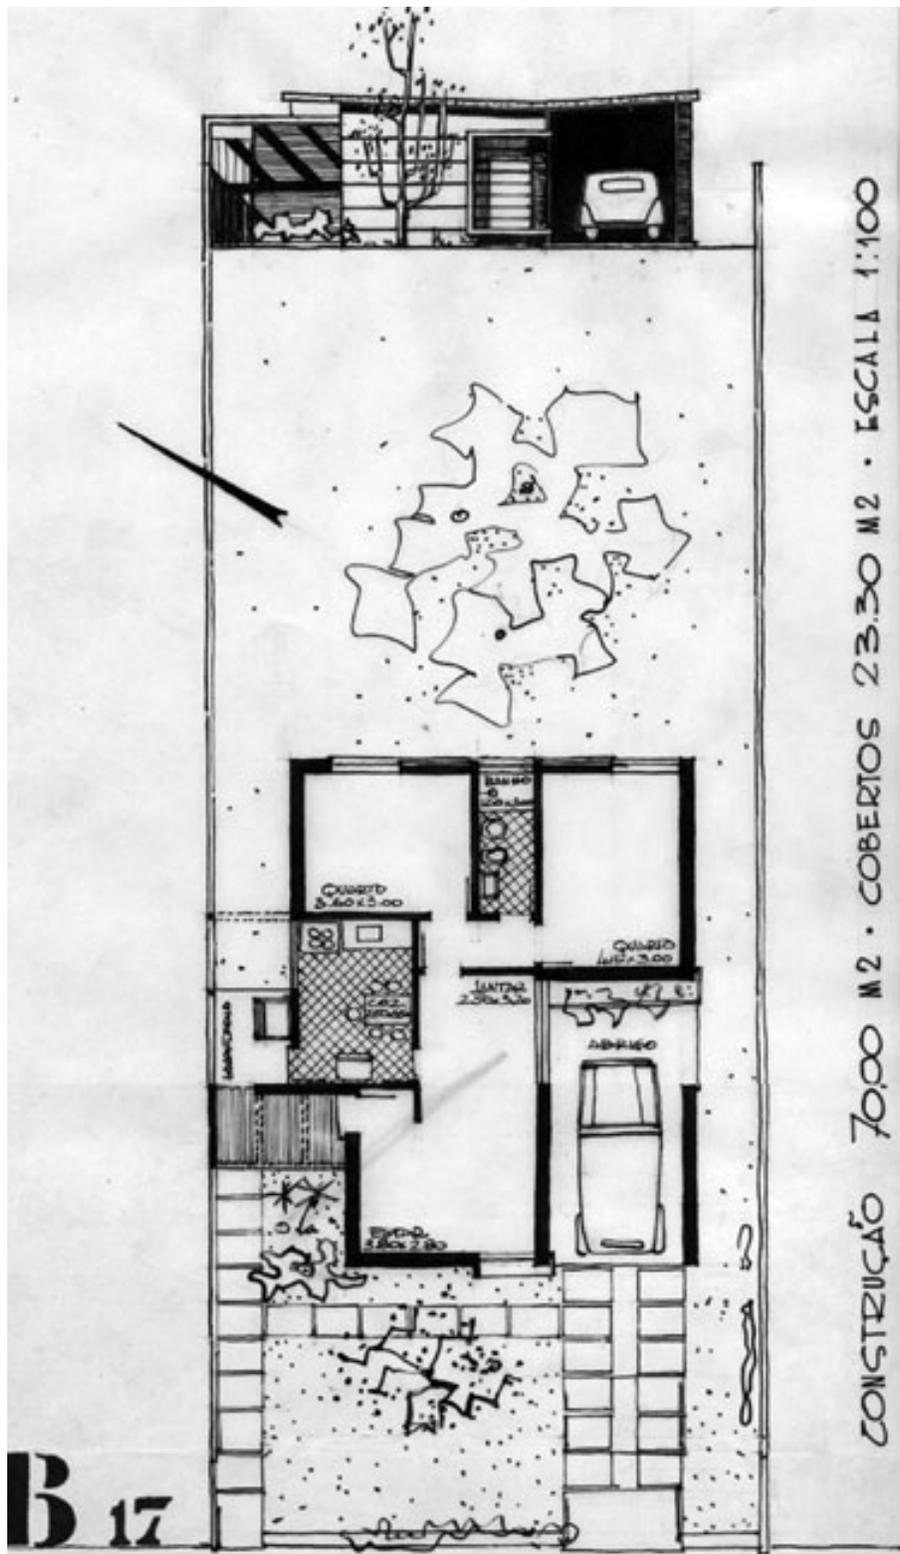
Resolução para residência de tamanho mais reduzido. Planta e fachada.
